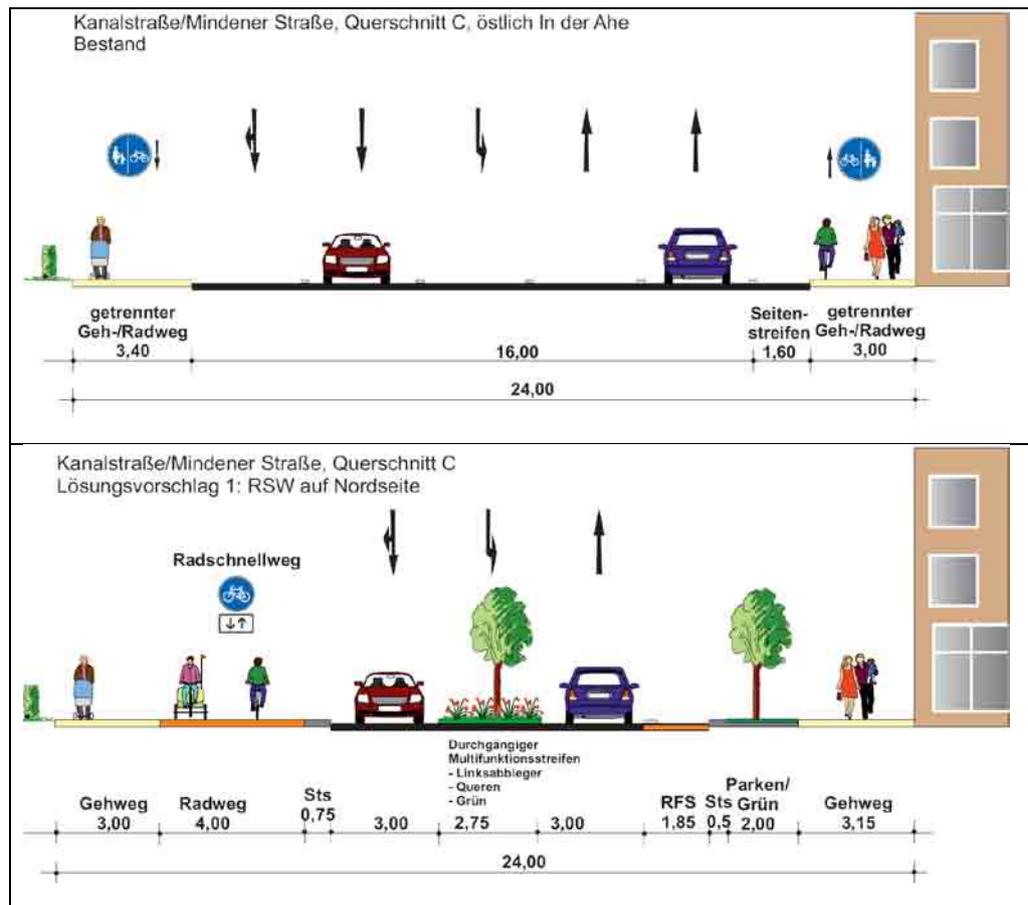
Radschnellweg auf Mindener Straße / Kanalstraße in Bad Oeynhausen
